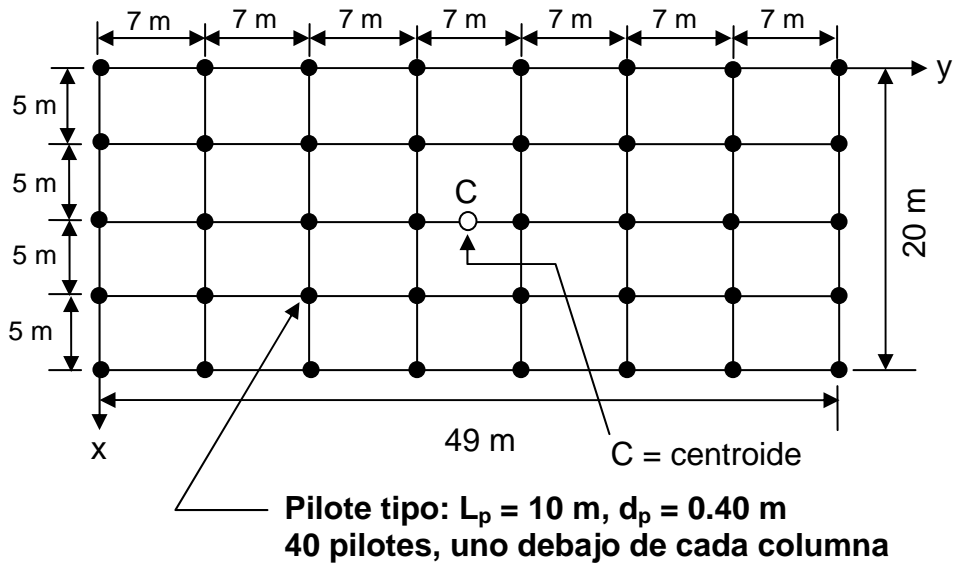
Distribución de pilotes en la cimentación del edificio de 14 niveles
